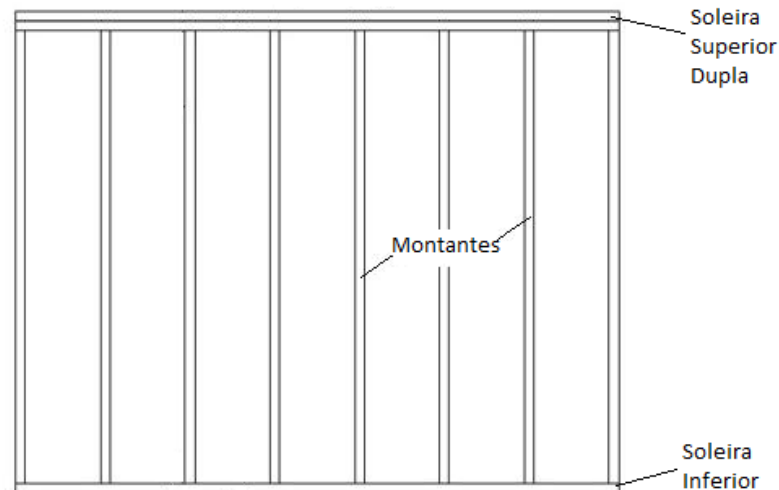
Esquema simplificado da estrutura em Wood Frame.
